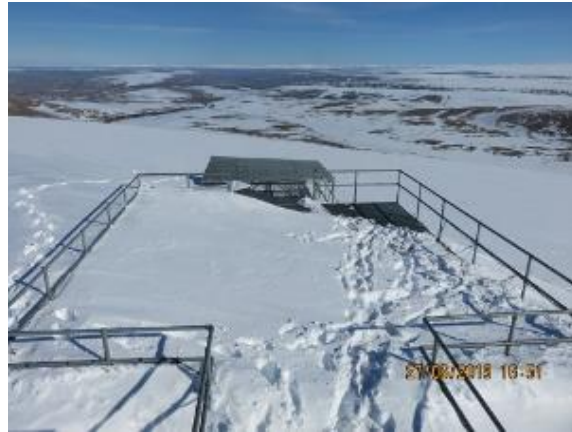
Vue en direction est – plateforme de la batterie à l'avant-plan et zone de chargement en arrière-plan
